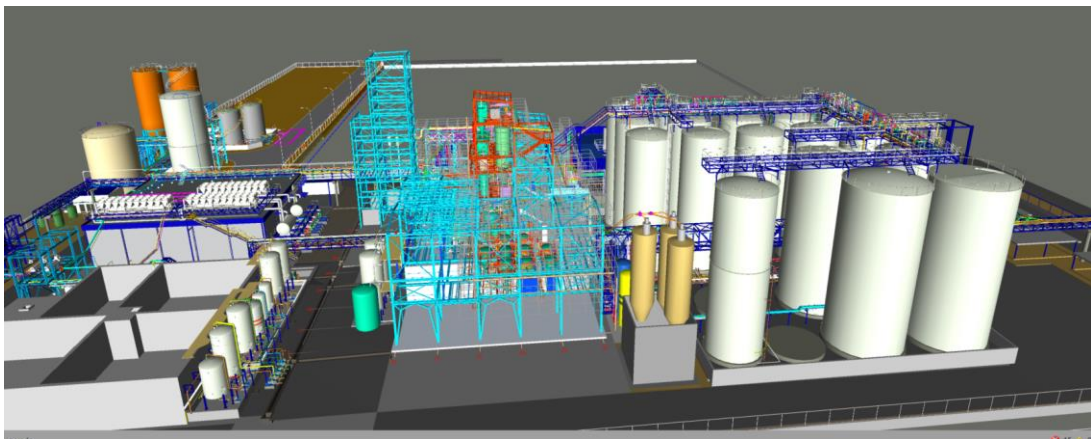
Visualización 1 en 3D de la planta [Fuente: Planta]
